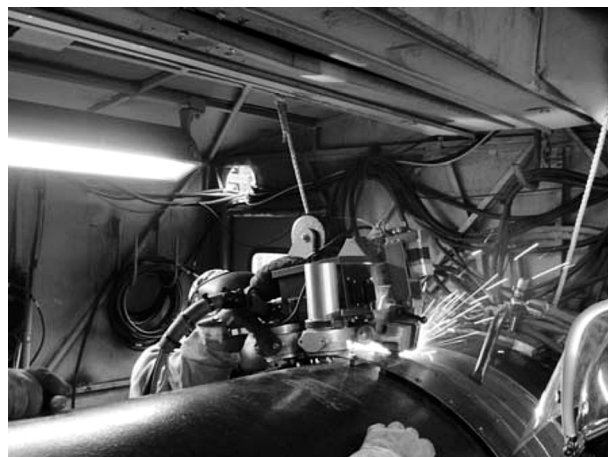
自動溶接施工（海外・陸上パイプライン）
